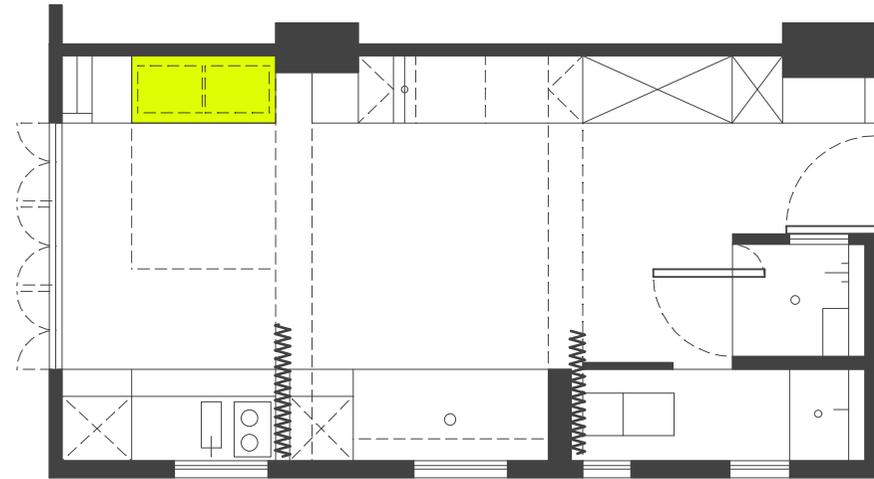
Grundriss „Domestic Transformer“ 2006, eigene Darstellung
